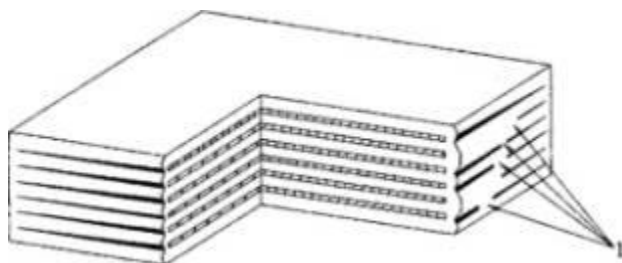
Вид боковых поверхностей резиновой опорной части с непрочлеем по торцам стальных листов под нагрузкой:
